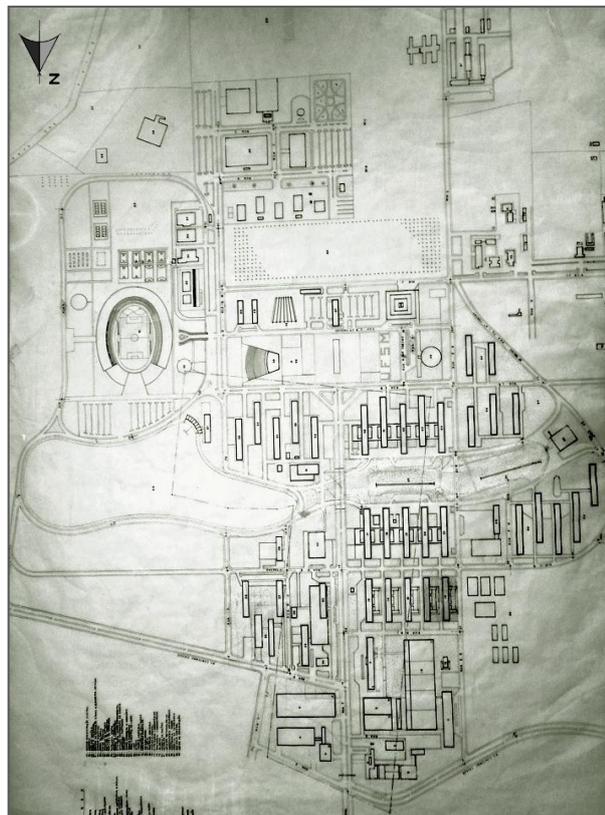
implantação do Plano Piloto de Valdetaro e Nadalutti para a Universidade de Santa Maria, 1962 (FONTE: Acervo da UFSM, 2010).
